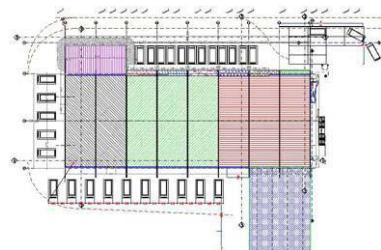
Piso con Concreto de Contracción Compensada tableros de 30x31 metros.
